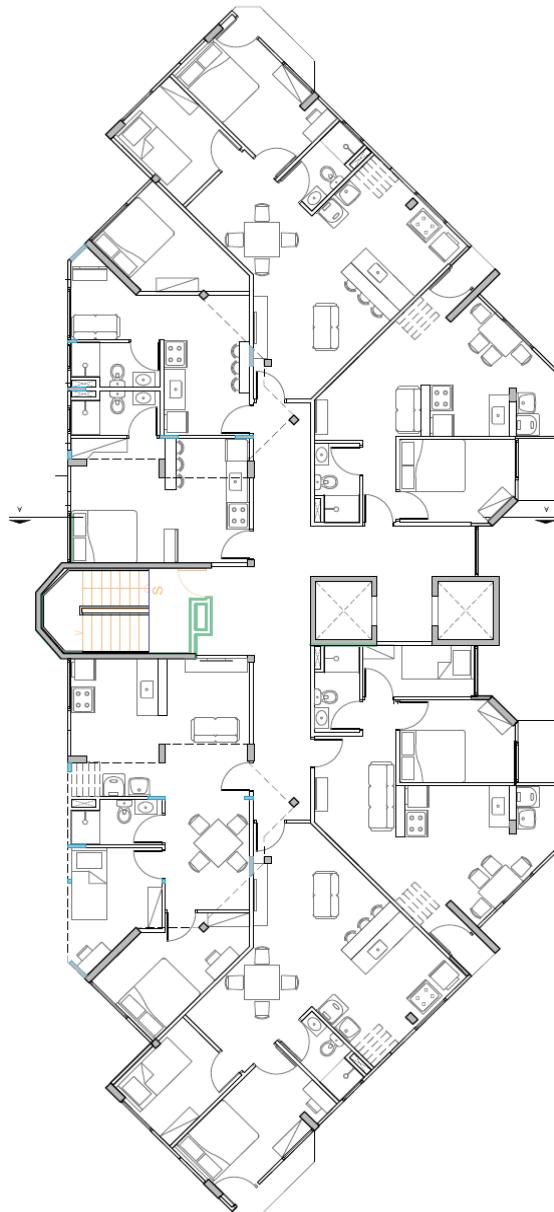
Projeto final da planta tipo dos pavimentos na edificação reabilitada. Acervo do Autor
